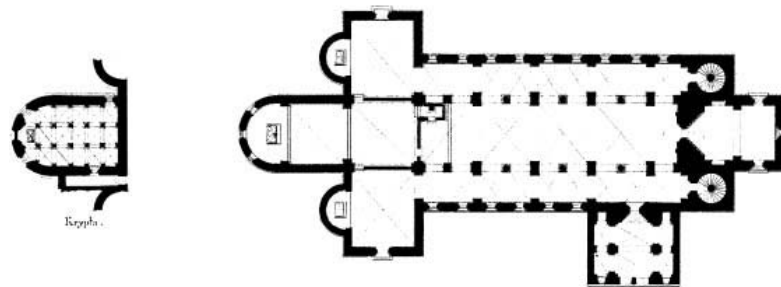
Goslar, ehem. Stiftskirche St. Simon und Judas, Grundriss (Rekonstruktion). Foto: <http://home.tu-clausthal.de/~exhh/dom/grundrisse.html>
